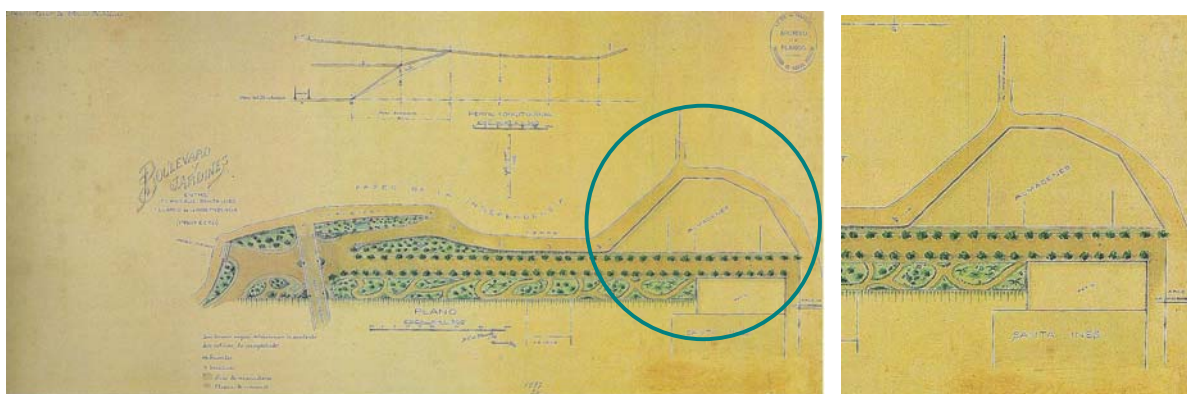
Boulevard y jardines entre el Pasaje Santa Inés i el Arco de la Independencia. Plano de conjunto y perfil longitudinal, esc. 1:500
